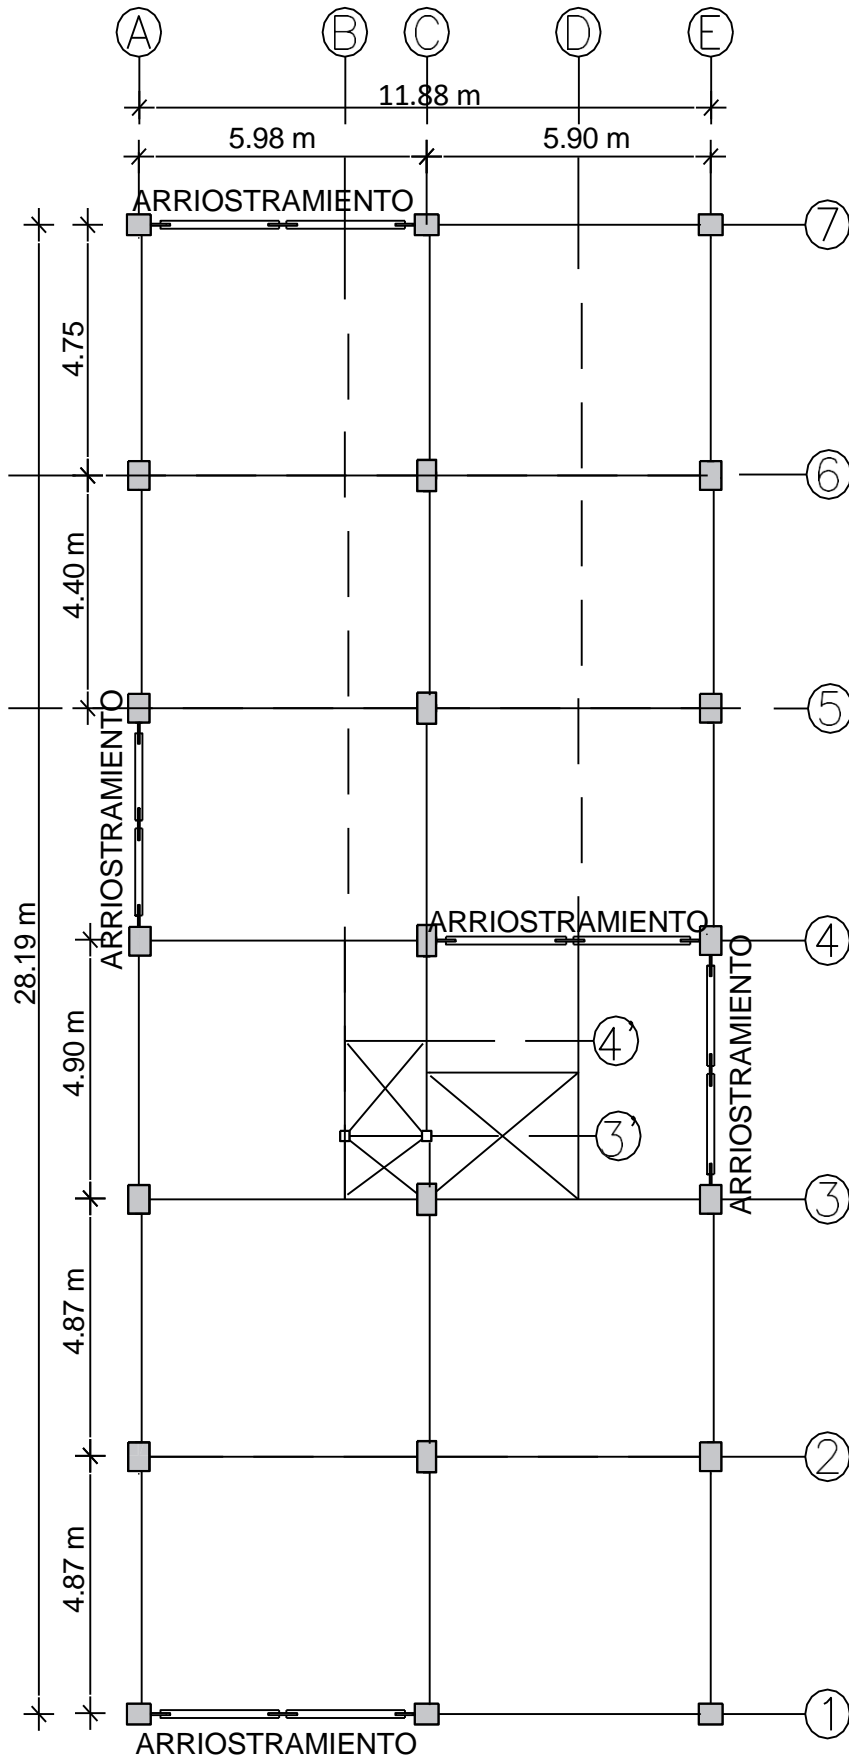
Edificio con arriostramiento concéntrico vista en planta
